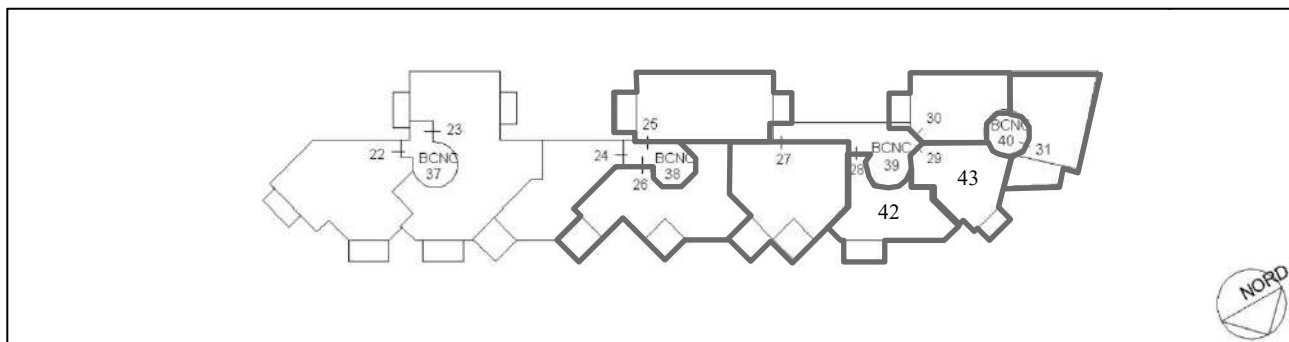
Estratto di Elaborato Planimetrico – Piano secondo – Beni oggetto di pignoramento (i sub 28 e 29 sono stati sostituiti per ampliamento dai sub 42 e 43)
